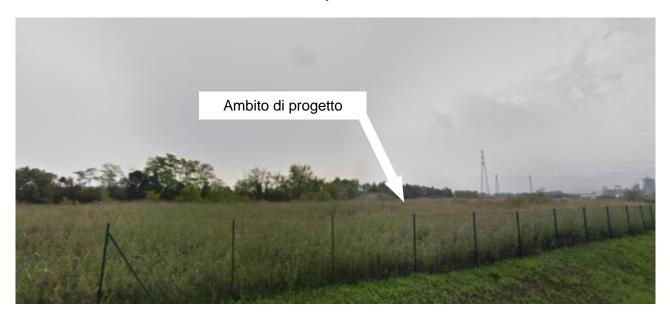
Foto della zona di progetto da via dell'Autostrada.
